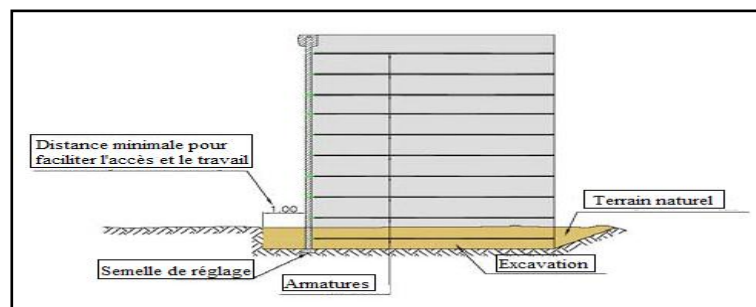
Parement en blocs préfabriqués et en grillage d'acier
